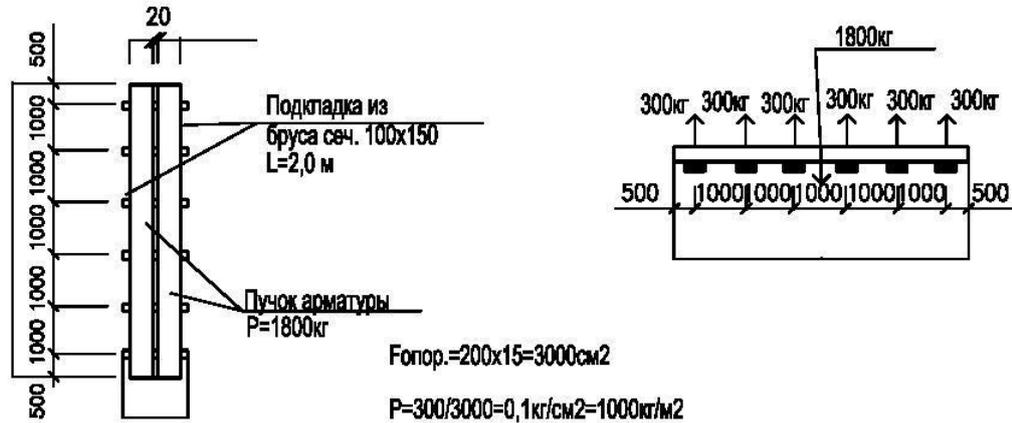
Расчет нагрузки на перекрытие от складирования опалубки
